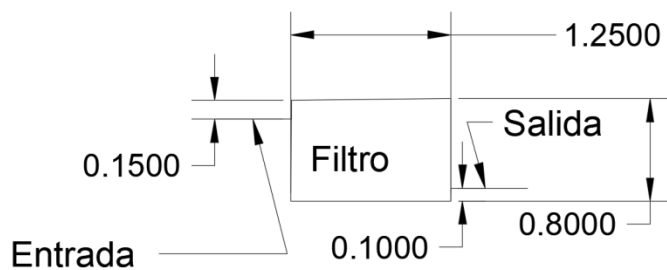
Pre dimensionamiento del filtro (perfil) unidades en m
